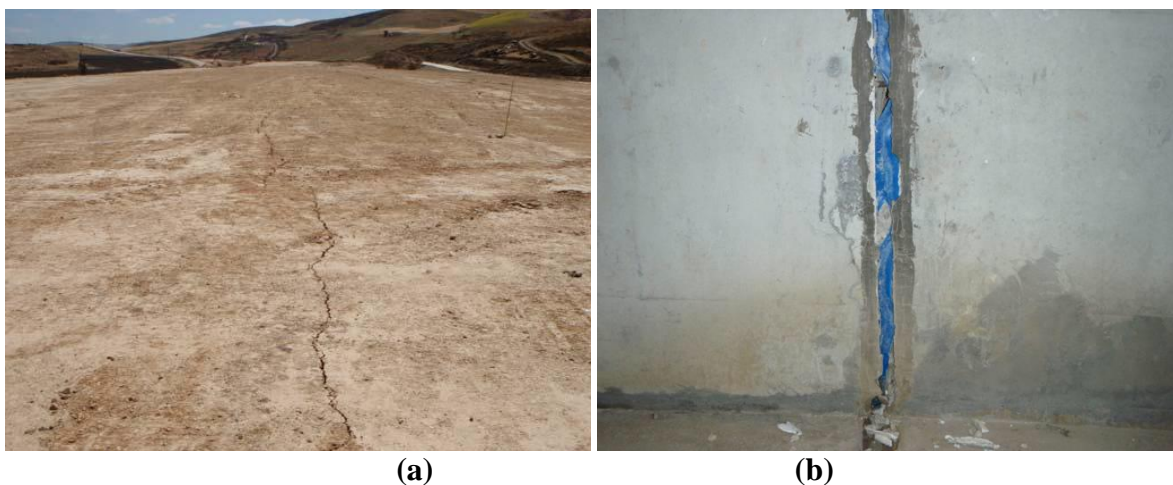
(a) Fissure sur la surface du remblai, (b) ouverture du joint de OH5
